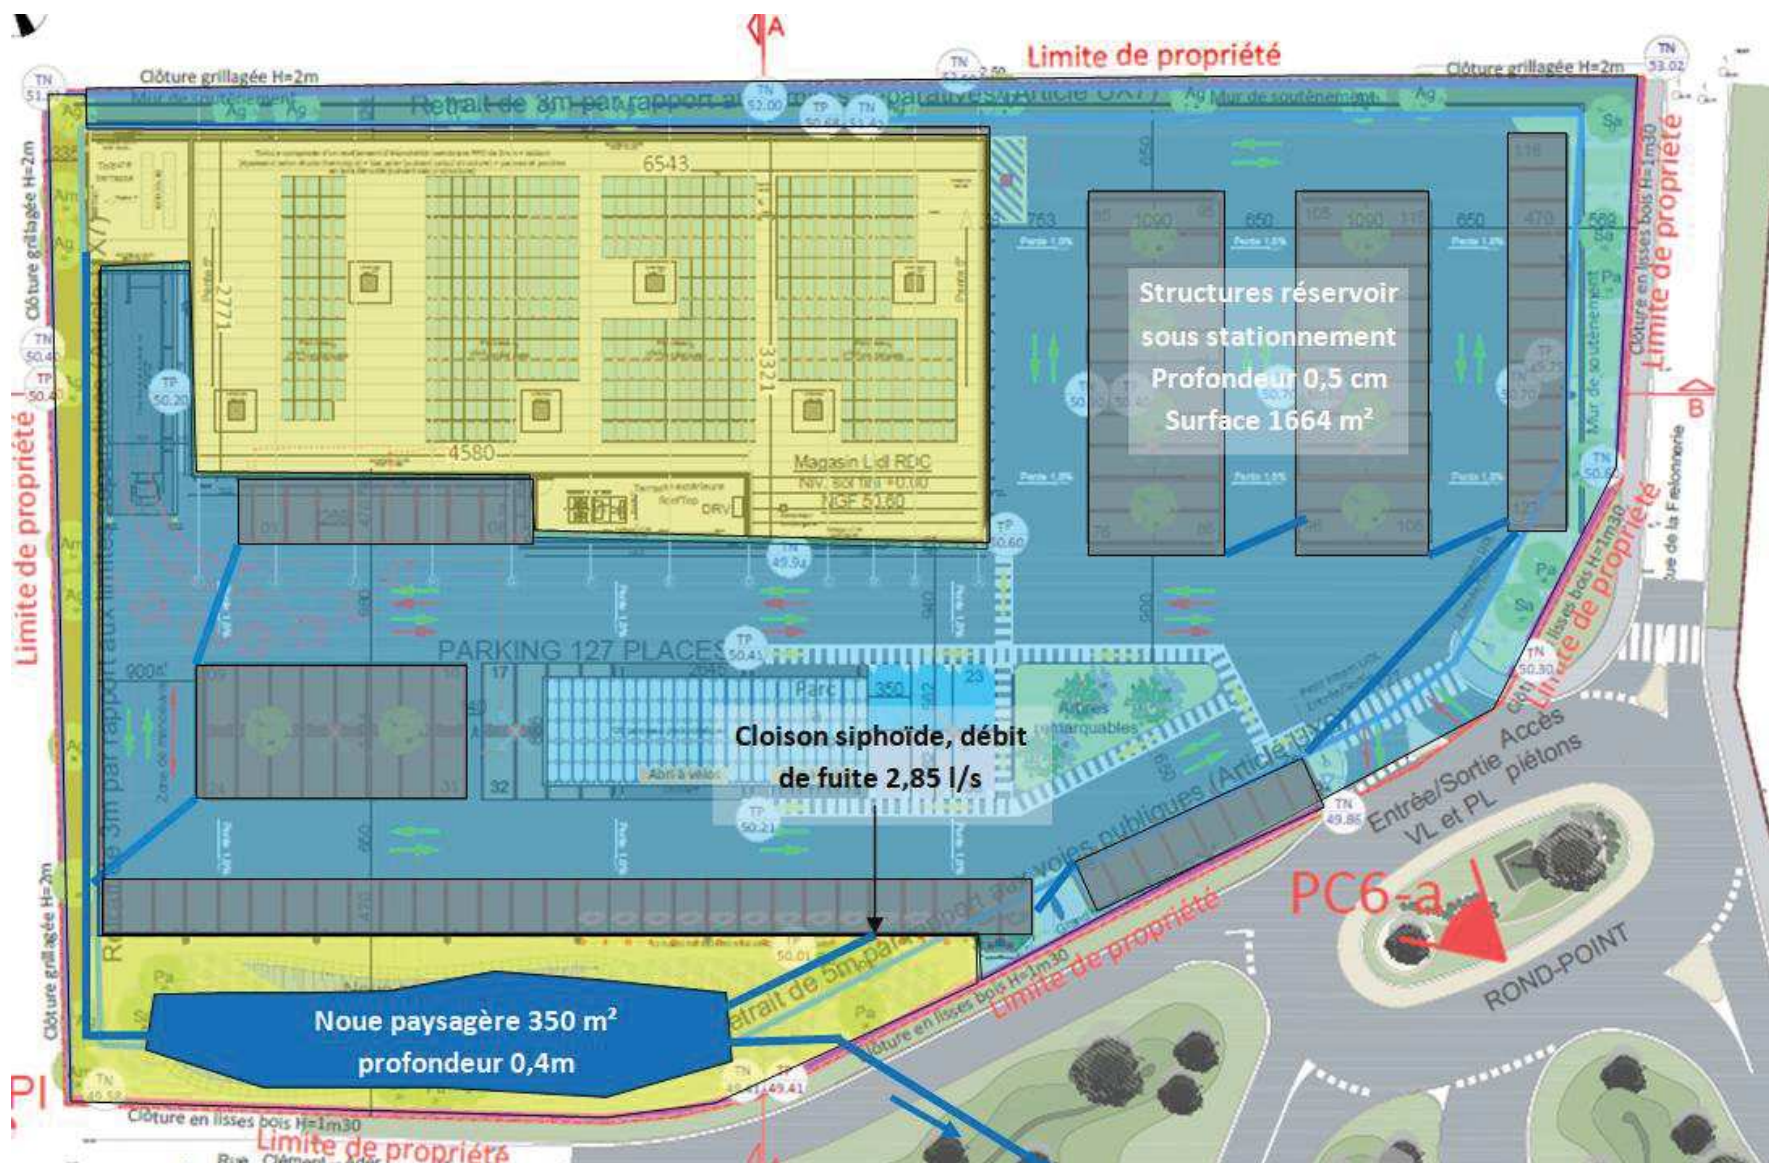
Plan de localisation des ouvrages de gestion des eaux pluviales
